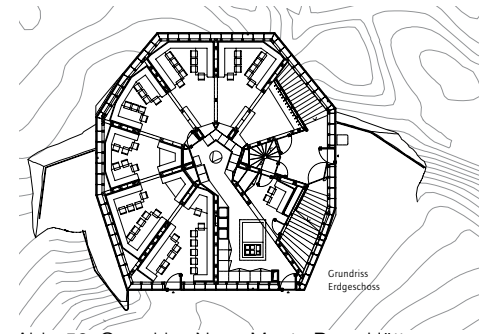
Grundriss Neue Monte Rosa Hütte
